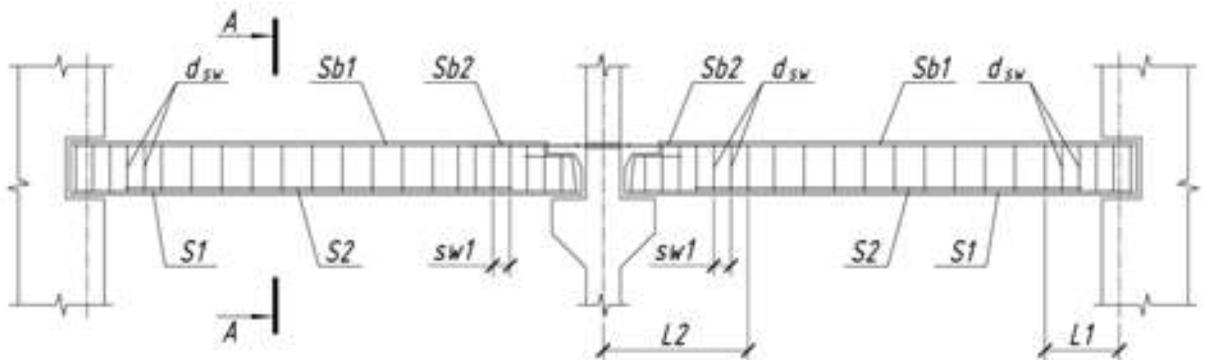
Схема расположения параметров армирования неразрезной железобетонной балки:  $S_1, S_2$  – продольная рабочая арматура в пролете;  $Sb_1, Sb_2$  – продольная рабочая арматура на опоре;  $d_{sw}$  – поперечная арматура;  $s_w$  – шаг арматуры
